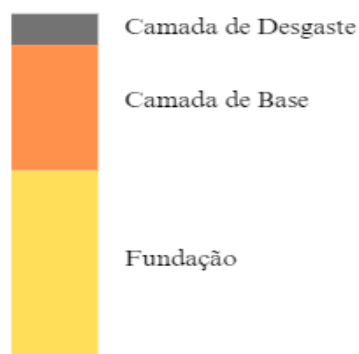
Estrutura do pavimento de estradas não revestidas
